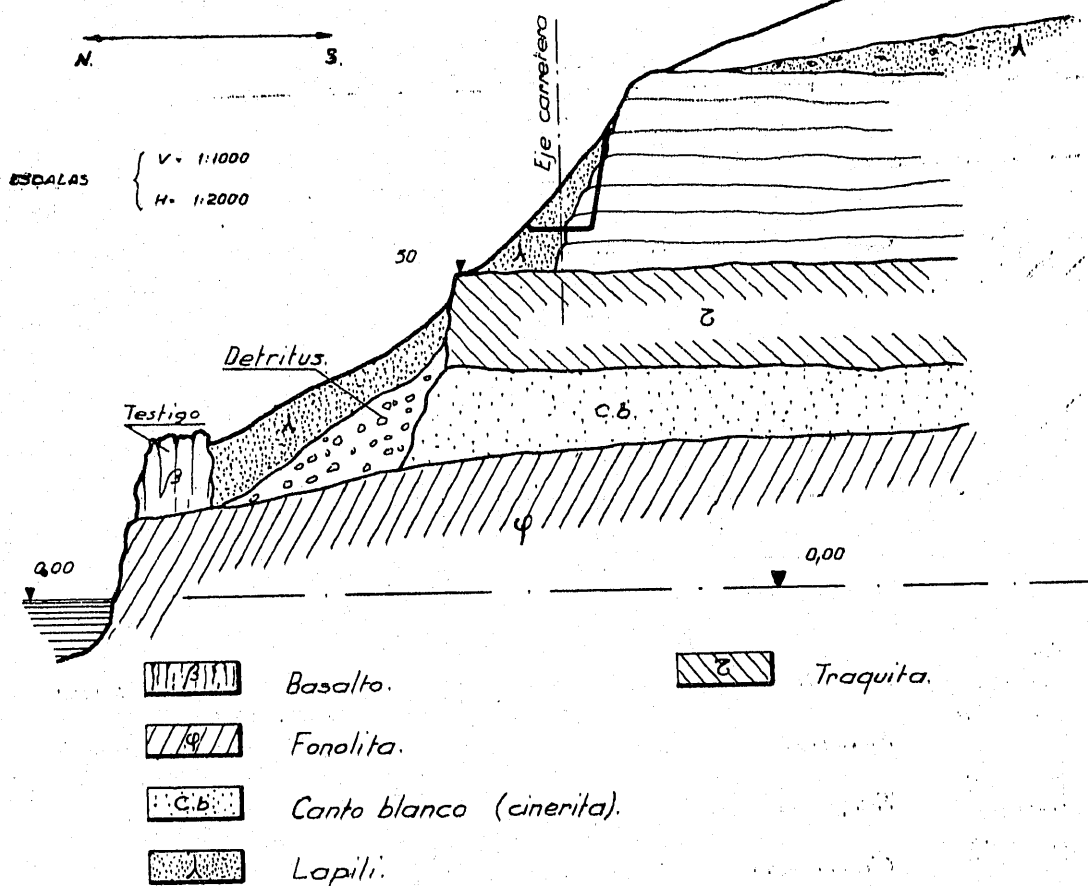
^a — Perfil geológico G-4; perfil transversal núm. 55.
